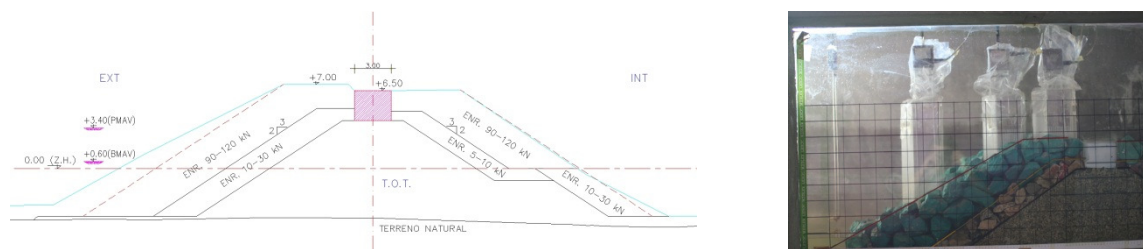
Vista transversal da secção do quebra-mar em estudo e da estrutura no canal de ondas.
